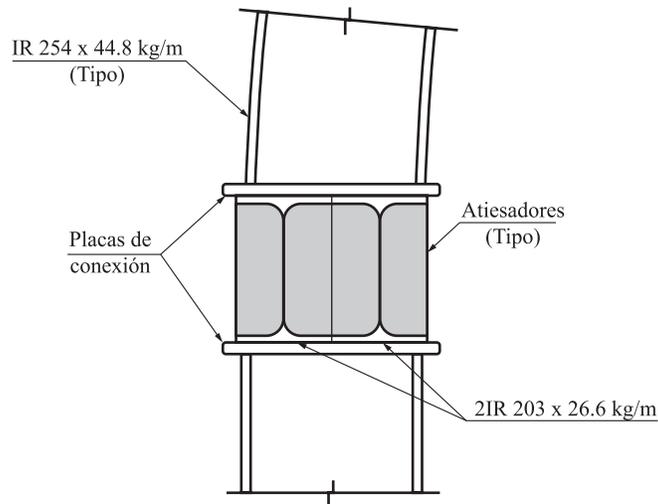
Esquema típico de rastras formadas por dos perfiles metálicos IR 203.
